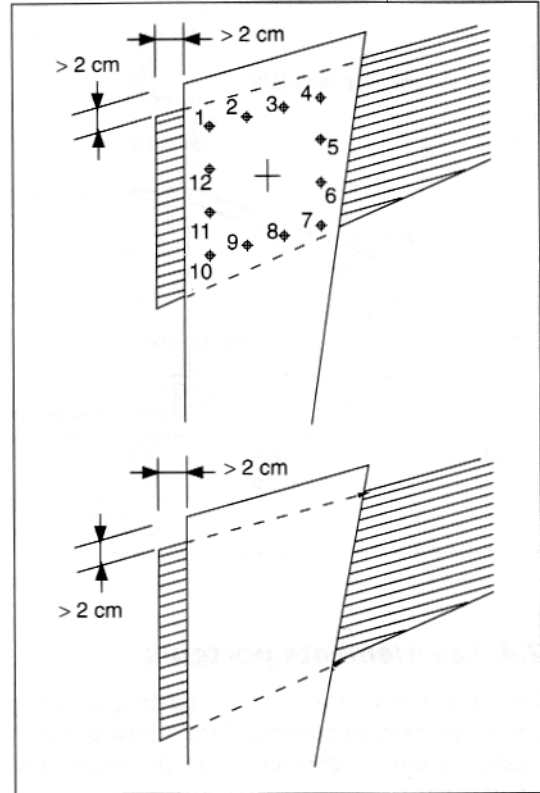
• Encastrement d'une traverse et d'un poteau de portique.
